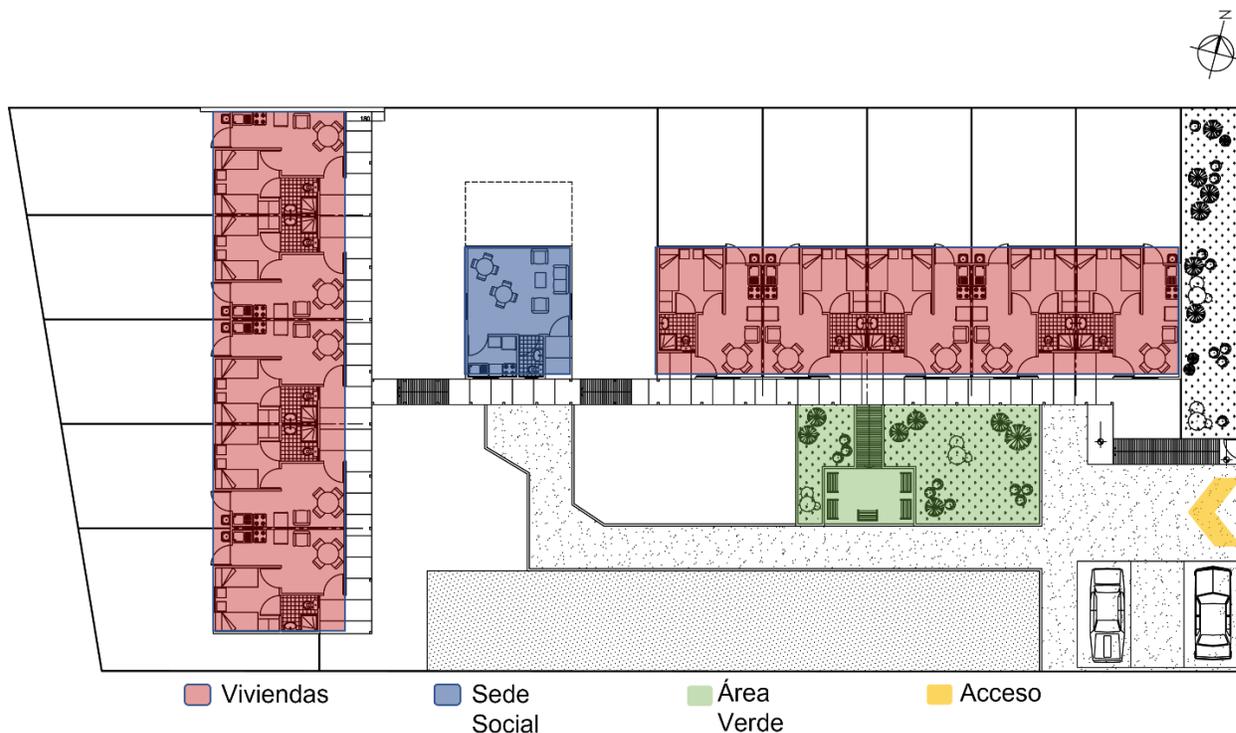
Plano Planta General CVT Penco. Fuente: Plano SERVIU solicitado mediante Ley de Transparencia.
